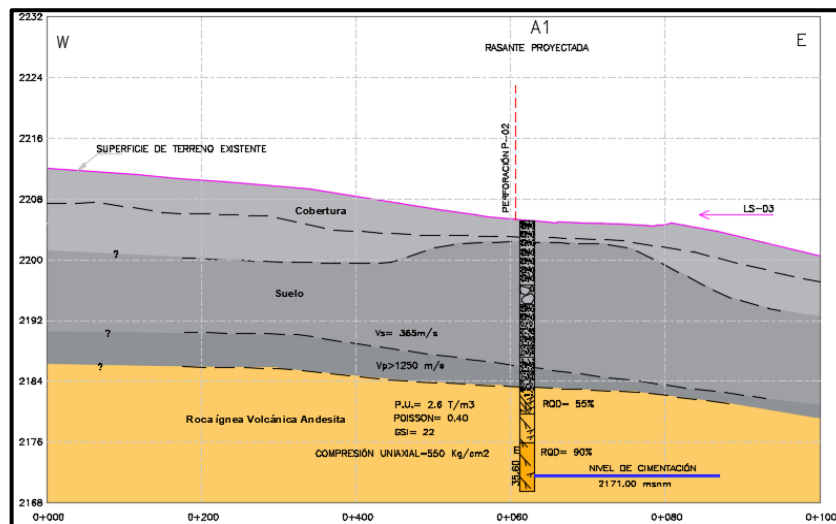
Zona de emplazamiento del Apoyo A1, con parámetros geotécnicos.
